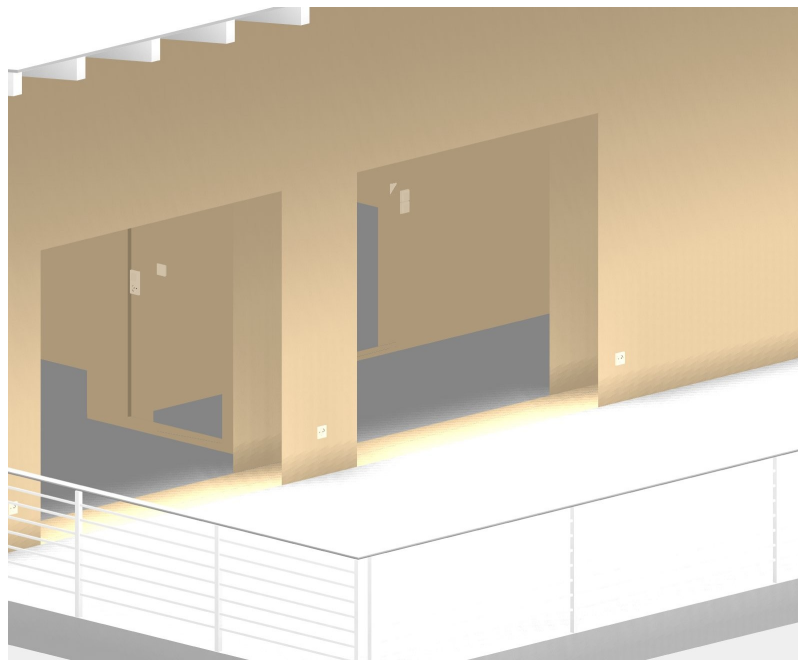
DDS : Elektroinstallation Außensteckdosen - Balkon
